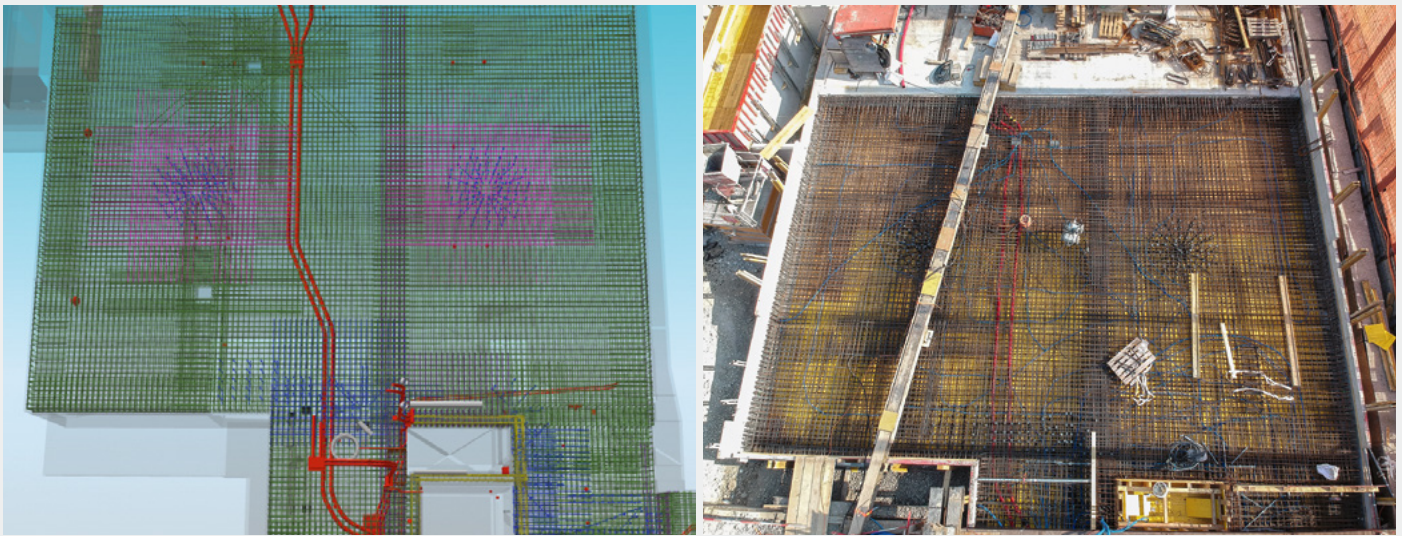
Bewehrungsabnahme ab Modell. Links: Modell auf Allplan BIMPlus; rechts: Baustellenansicht
